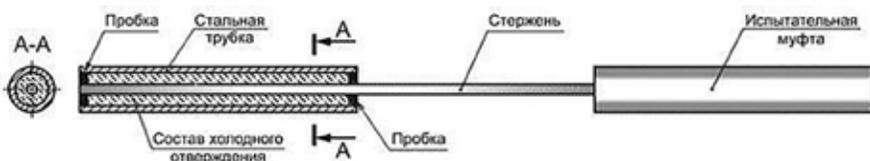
Вид типового опытного образца согласно ГОСТ 32492–2015
